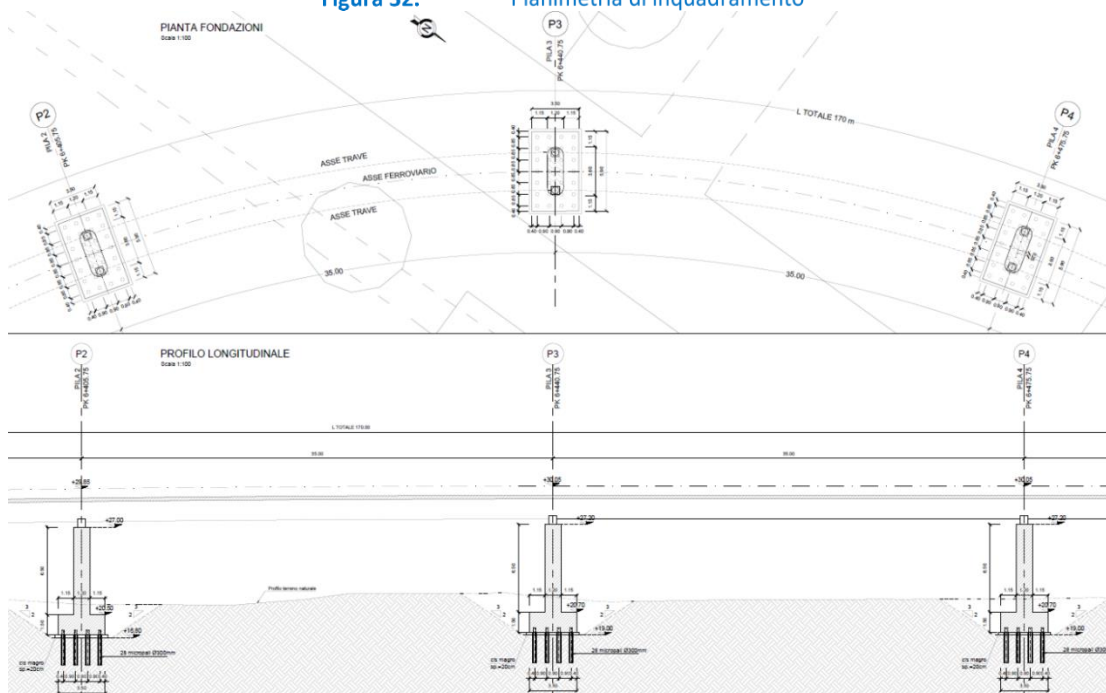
Stralcio pianta fondazioni e profilo longitudinale (campate 3 e 4)
